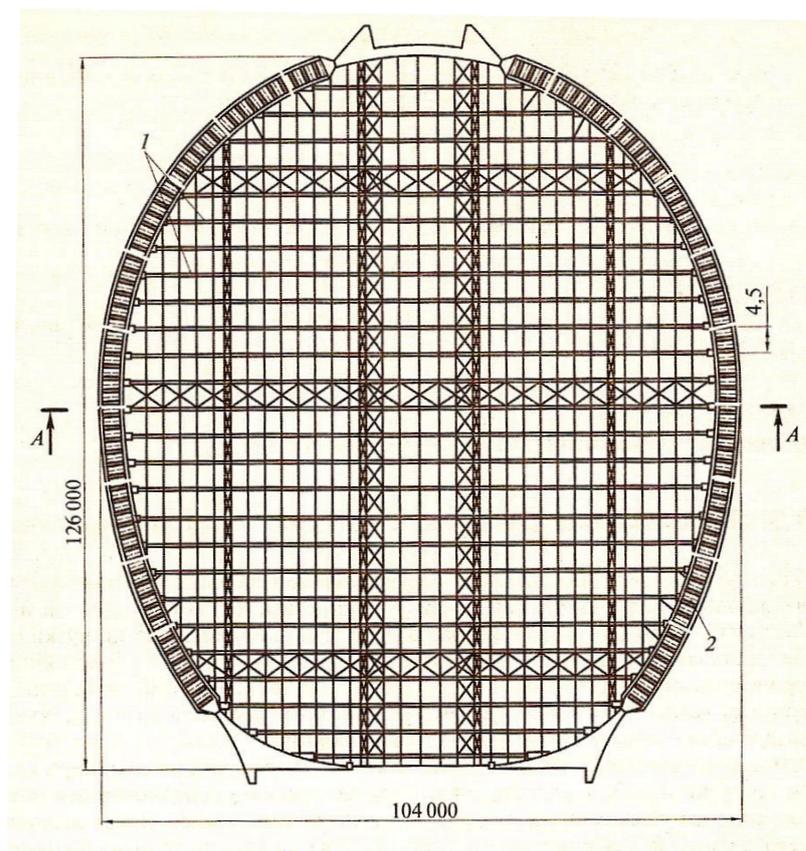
Покрытие с изгибно-жесткими вантами в виде ферм
